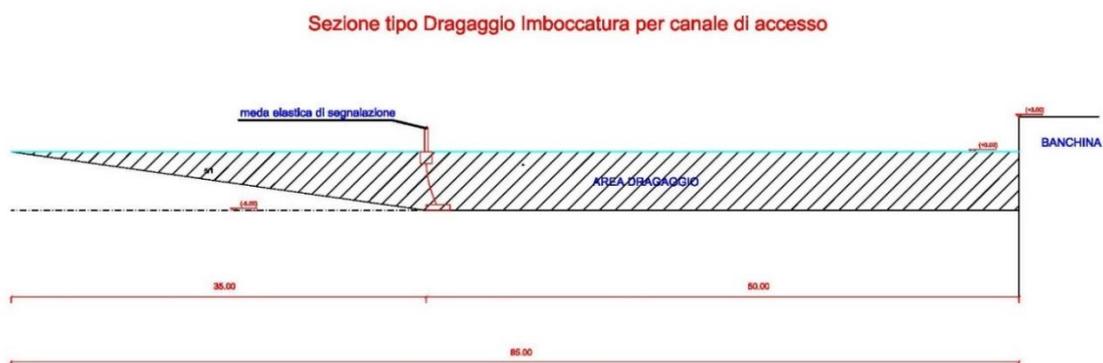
Sezione TIPO dragaggio imboccatura per canale di accesso portuale
